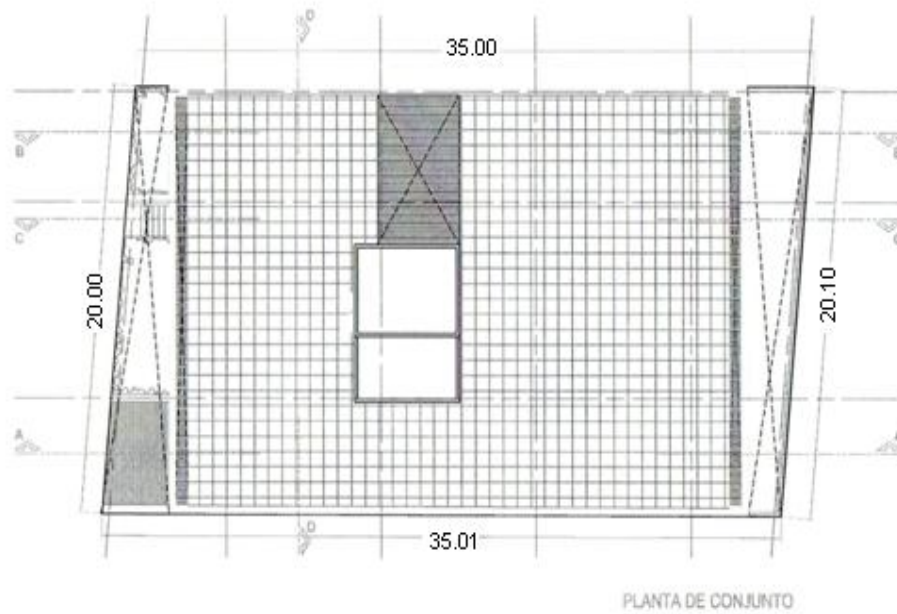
SEMBRADO DE ESTRUCTURAS PLANTA DE CONJUNTO
